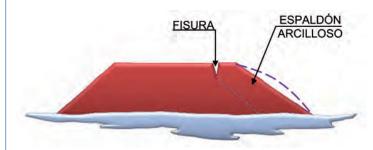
Fisuración por cambio de volumen en espaldón
